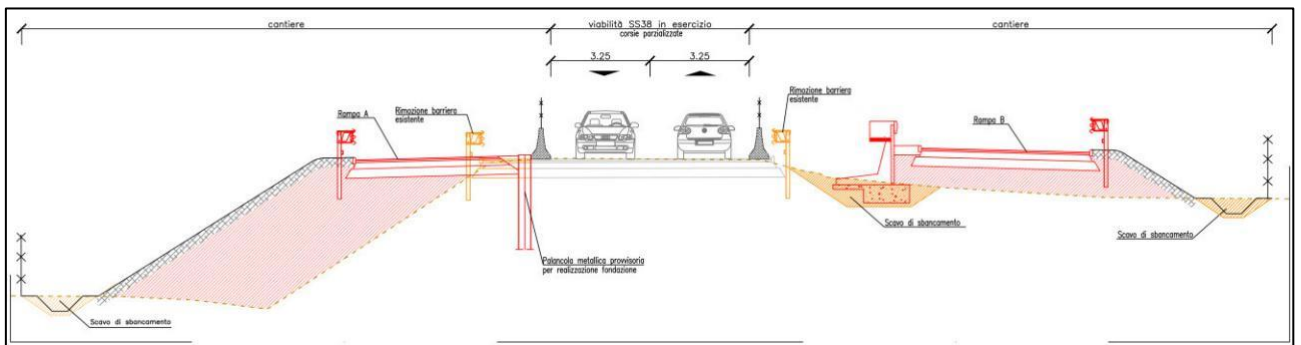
Sezione A-A Fase 3 Variante S.S. n. 38
